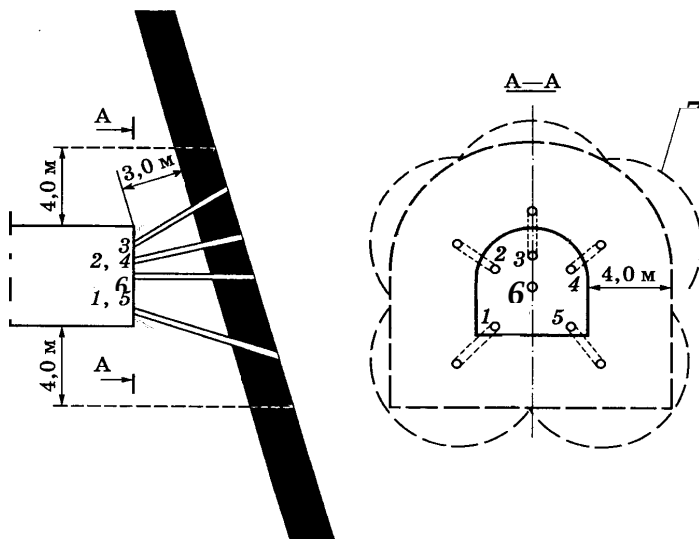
Схема розташування свердловин для гідророзпушування перед розкриттям крутого вугільного пласту: 1,2,3,4,5 — свердловини для гідророзпушування пласту; 6 — контрольна свердловина; 7 — контур обробленої частини пласту
